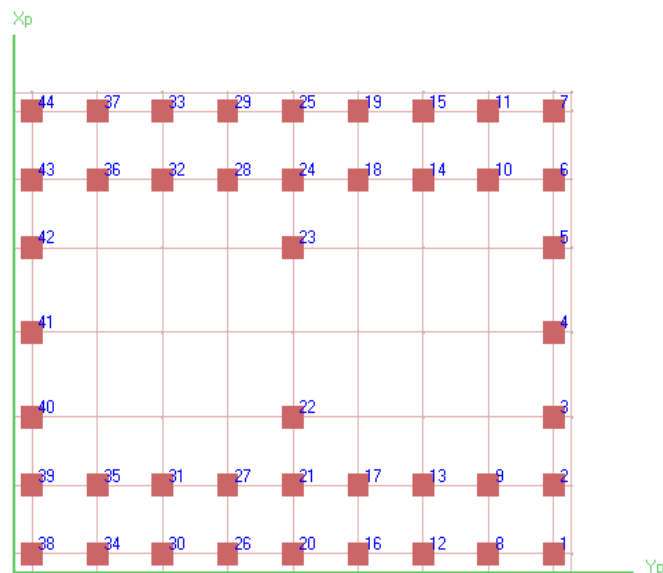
Planta de fundação realizada no *FB-Multiplier
